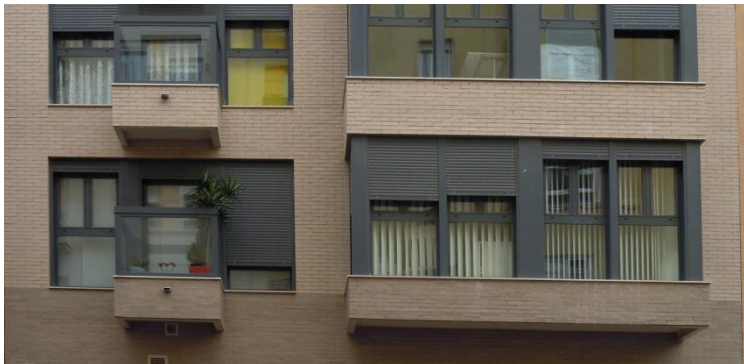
Partes de encuentro de la fachada con la carpintería en edificio de estudio.
